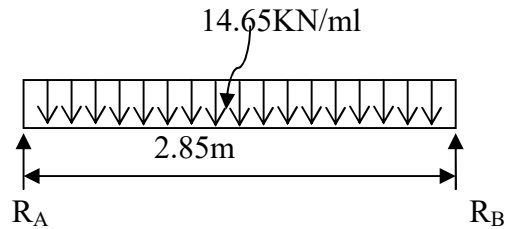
Schéma statique de poutre palière à l'ELS.
